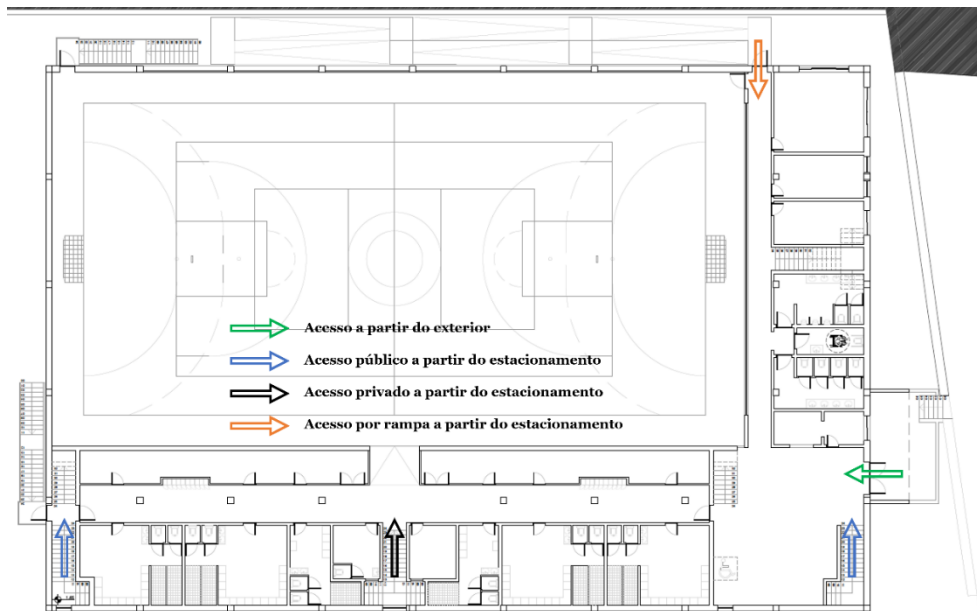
Planta esquemática sem escala dos acessos ao pavilhão
